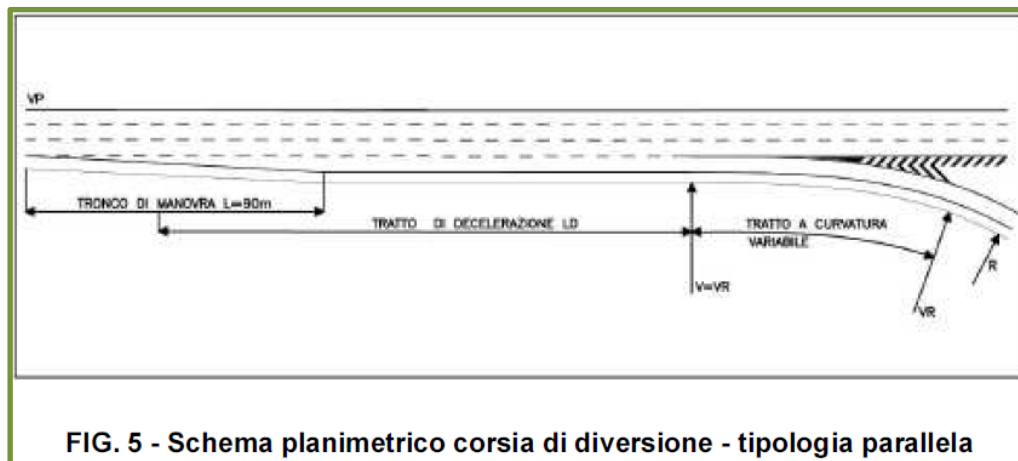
Schema planimetrico corsia di diversione - tipologia parallela
